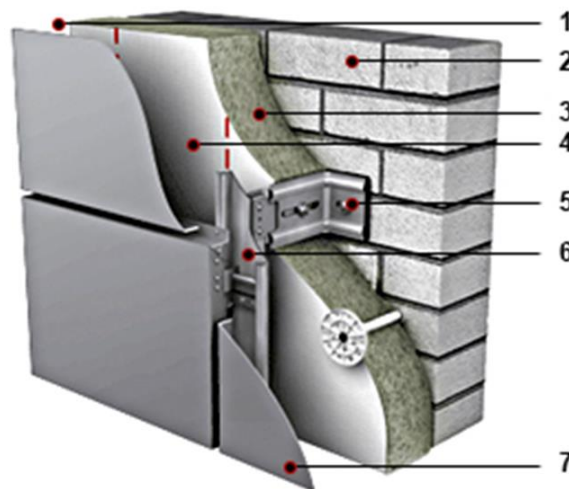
Утеплення стін за методом «вентильованого фасаду»:
